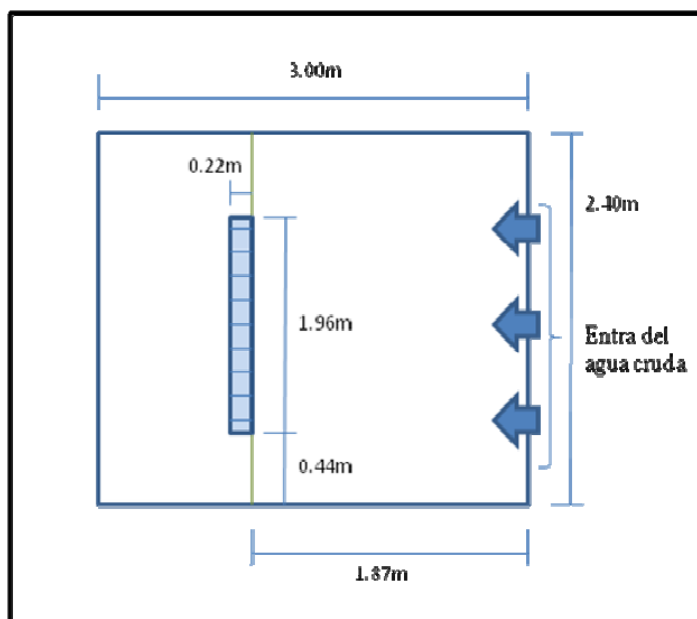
Dimensiones del tanque de reacción en vista de planta
